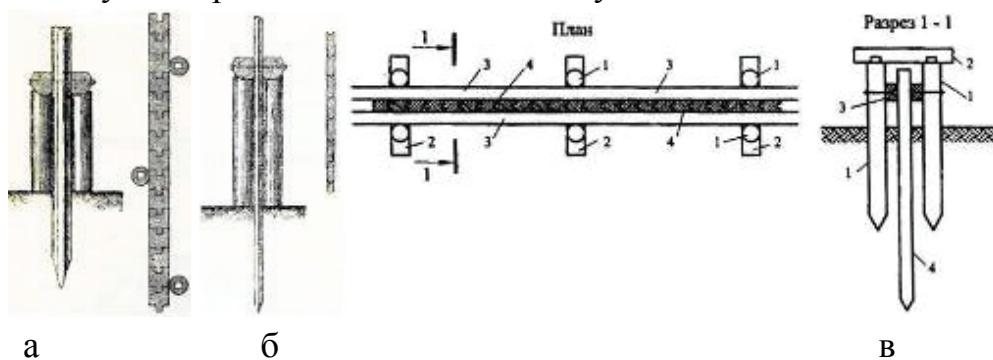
Брускатые (а) и досчатые (б) шпунтовые свайные ряды; в – организация забивки деревянных шпунтовых свай с применением маячных свай и направляющих брусьев: 1 – маячные сваи; 2 – схватки; 3 – направляющие брусья; 4 – шпунтовые сваи; ход забивки шпунта – слева направо; по окончании работ направляющая конструкция разбирается.
